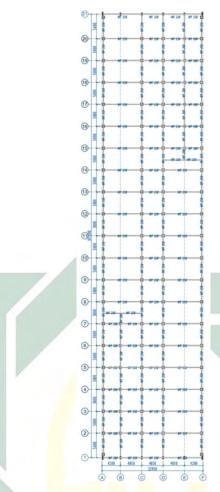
14 Denah Pondasi pa<mark>da Ramp</mark> Parkiran Mobil
